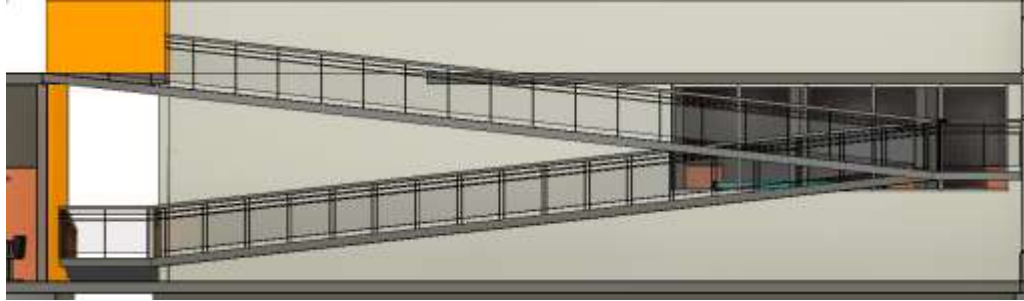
Vista Lateral Rampas, Fuente: Elaboración Propia.
